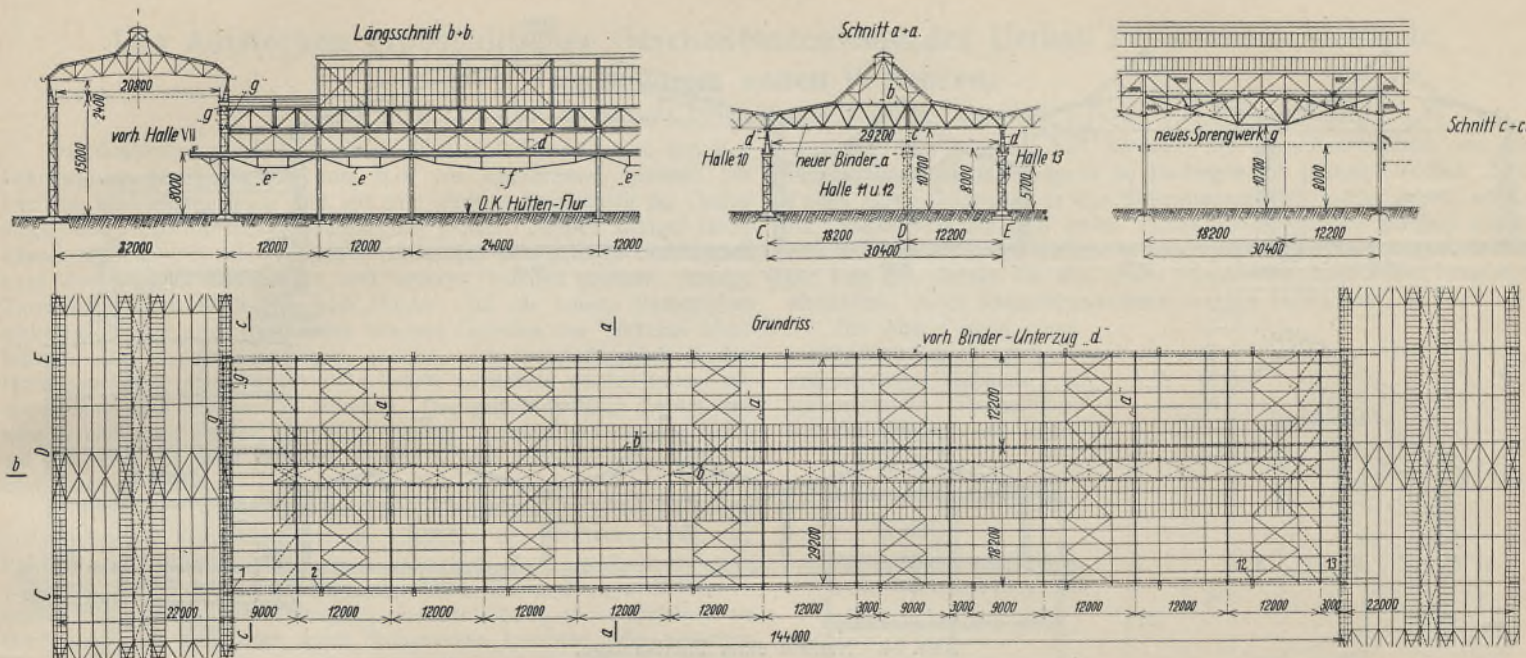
Grundriß und Schnitte der bestehenden Hallen eines Walzwerkes mit eingebauter neuer Stahlkonstruktion.
